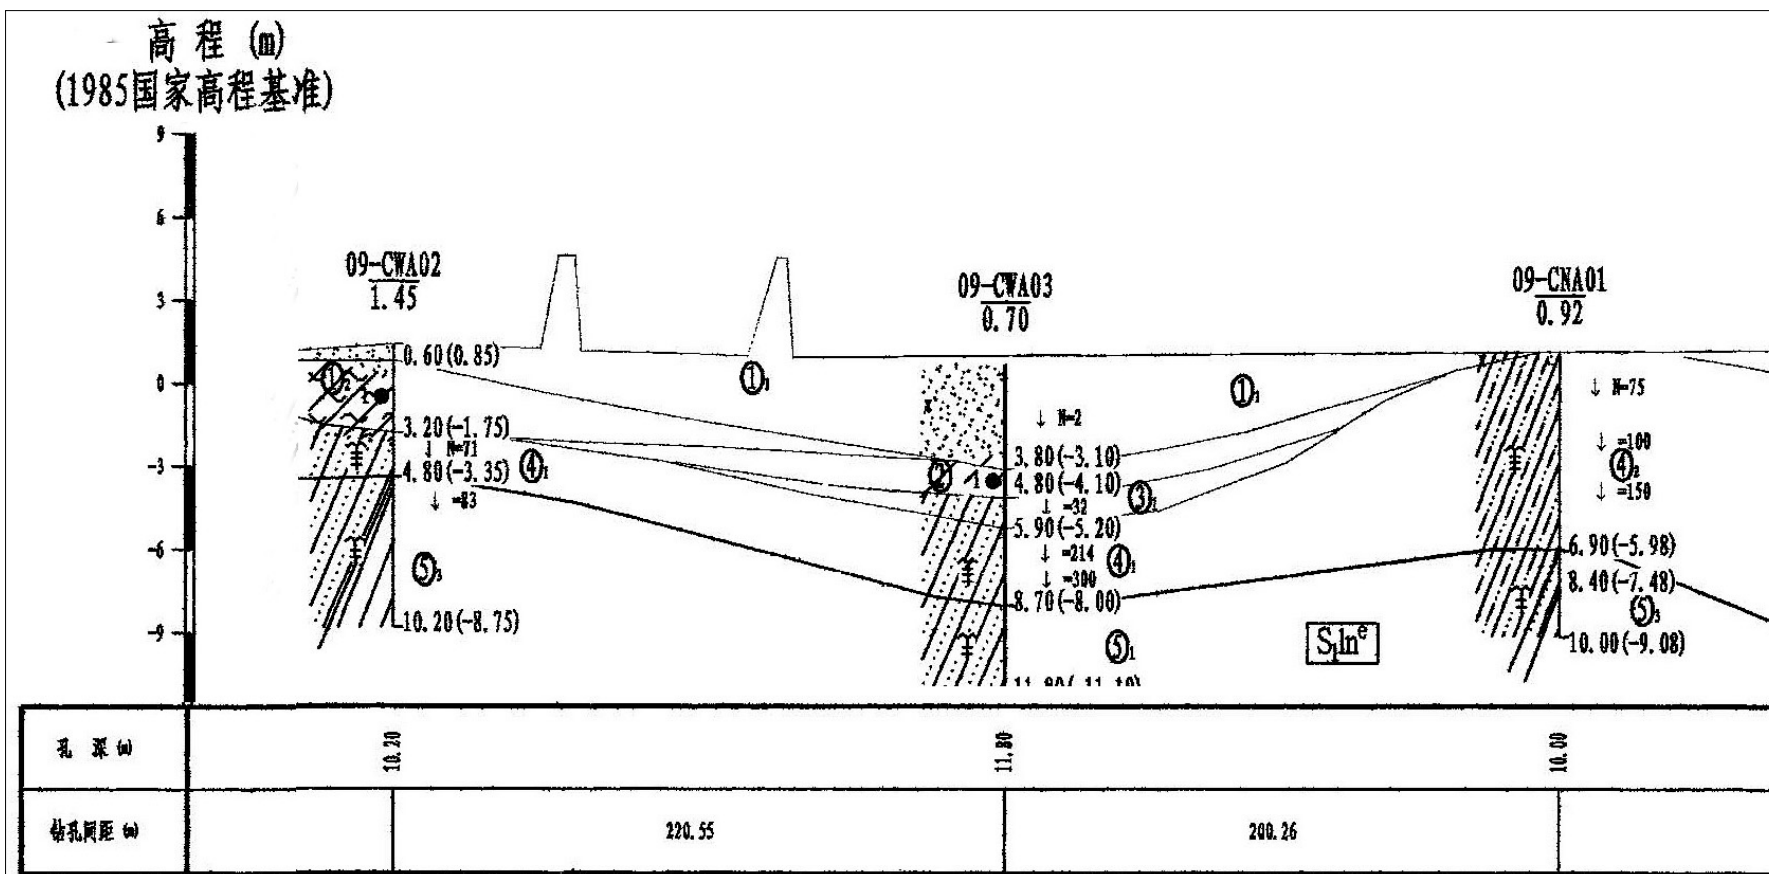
地质剖面图 (B9-B9' 剖面节选)
